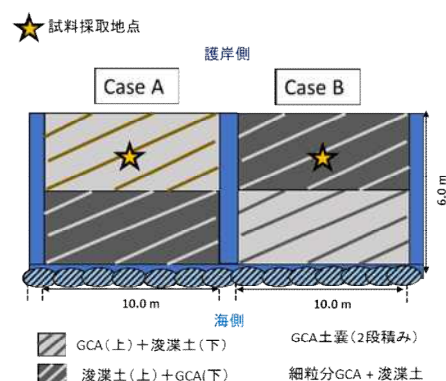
干潟造成実証試験区の平面図 (CaseA, B)
